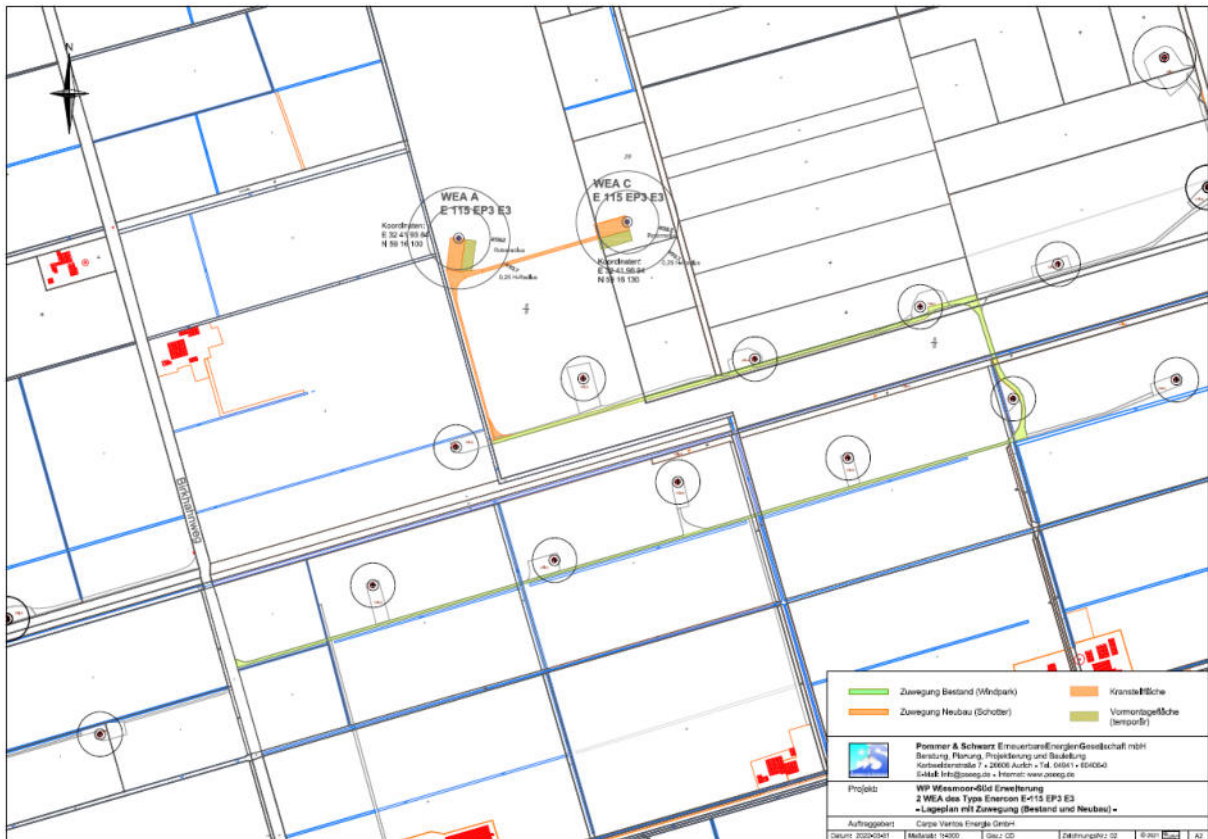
Geplante Zuwegungen zu den neuen Windenergieanlagen WEA A und WEA C (Ausschnitt aus dem Lageplan, POMMER & SCHWARZ 2021).
